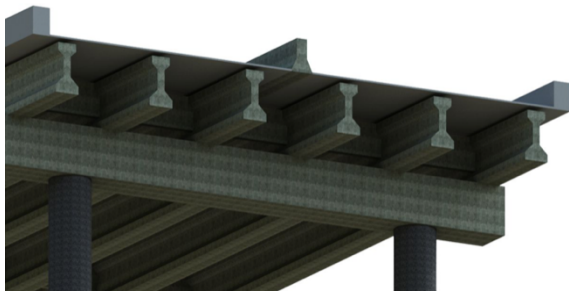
Tablero de puente sobre vigas tipo AASHTO.
